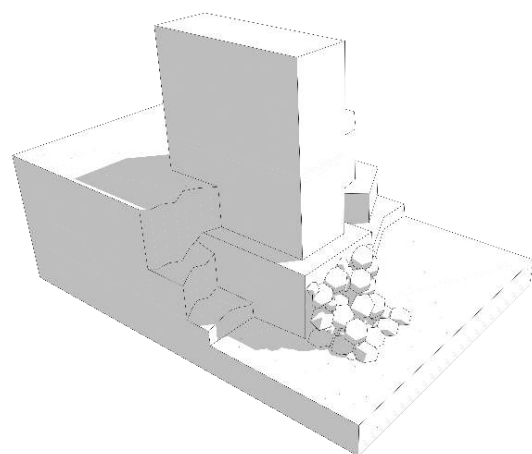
Detalle Constructivo Cimentación. Autor Propio. 2015
